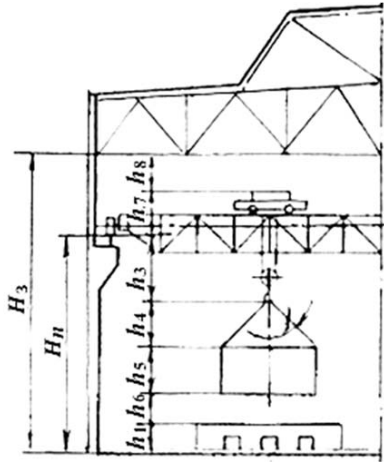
Основные размеры промышленного здания, снабженного верхним транспортом
